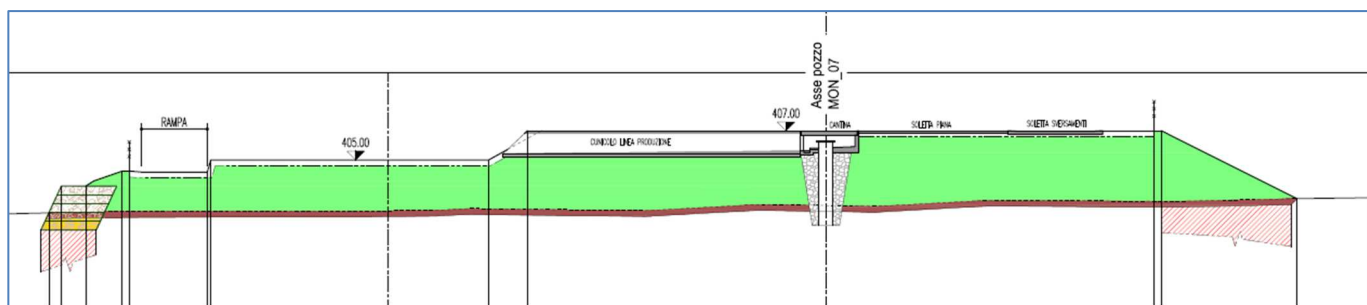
Sezione trasversale dell'opera con evidenza delle opere di sostegno, da elaborato di progetto (GRE.EEC.D28.IT.G.13405.00.034.00)
